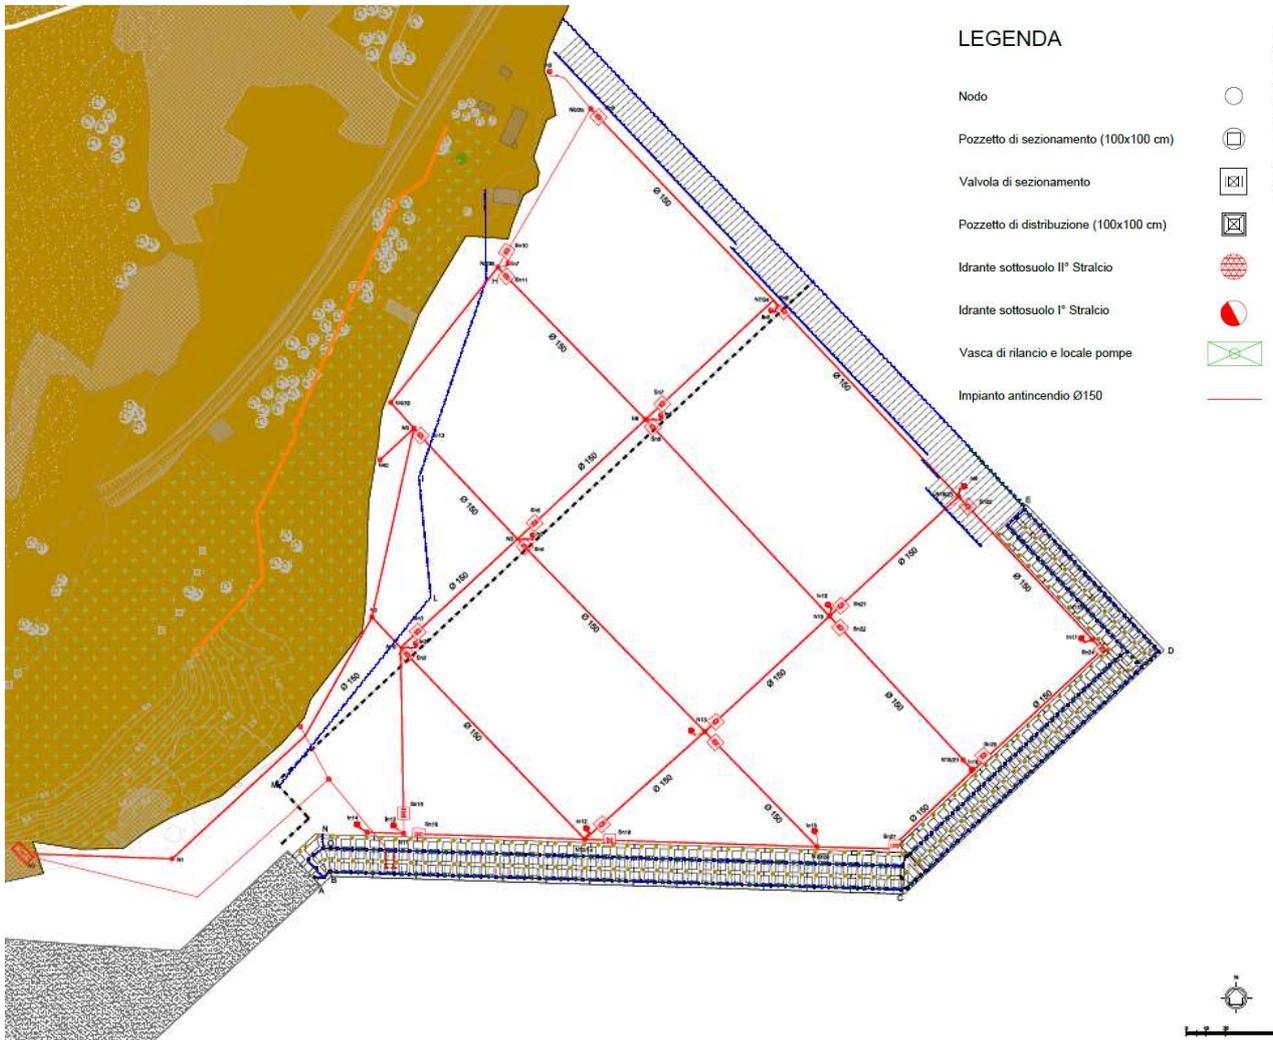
Planimetria rete antincendio Progetto Esecutivo
